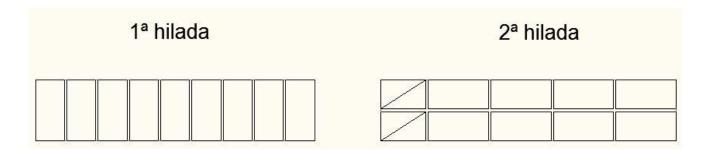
Disposición de las hiladas del muro según aparejo inglés. Elaboración propia
